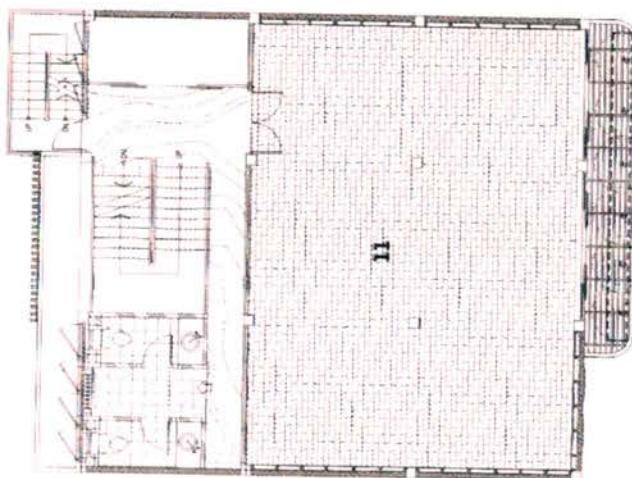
แสดงส่วน 1th Floor Plan
